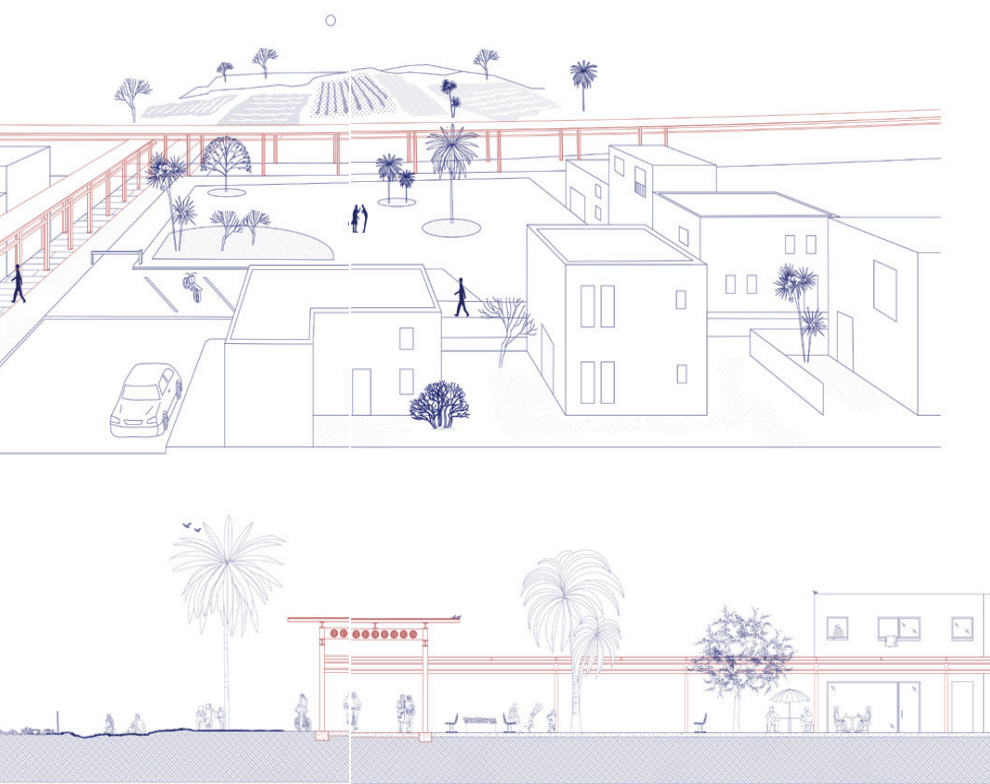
\_ coupe perspective et coupe en travers; en rouge, la galerie/ technoduc
